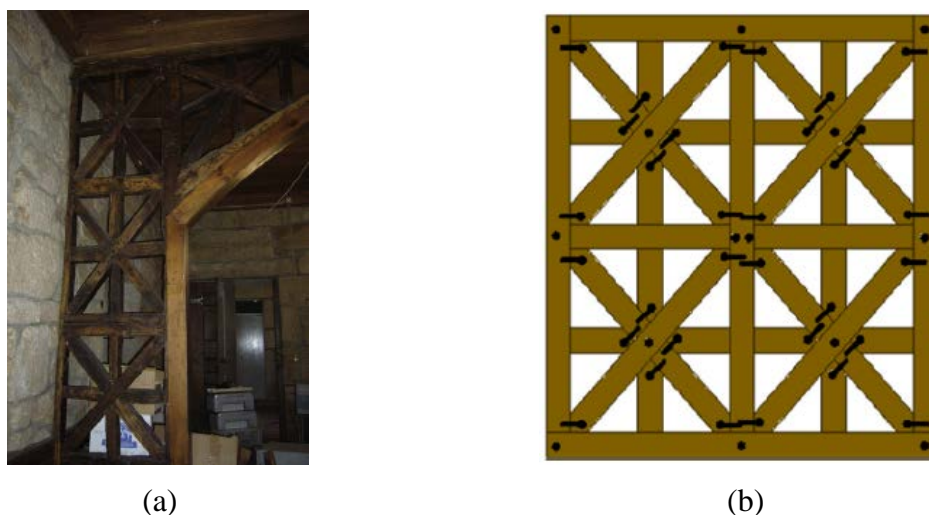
Definição do painel de ensaio; (a) parede no norte do país; (b) painel adotado e localização dos pregos.
